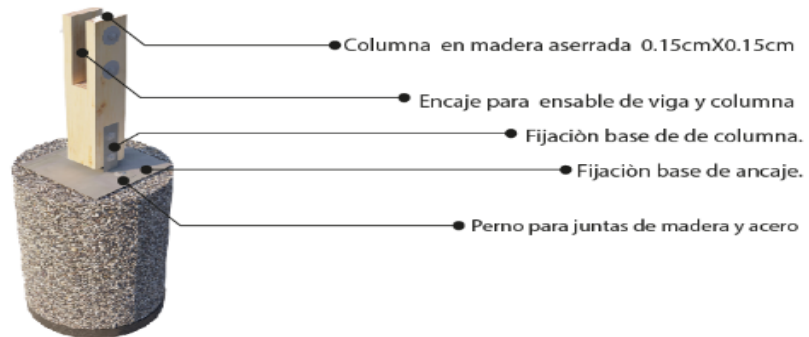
Detalle de anclaje con la cimentación. Elaboración Propia.
